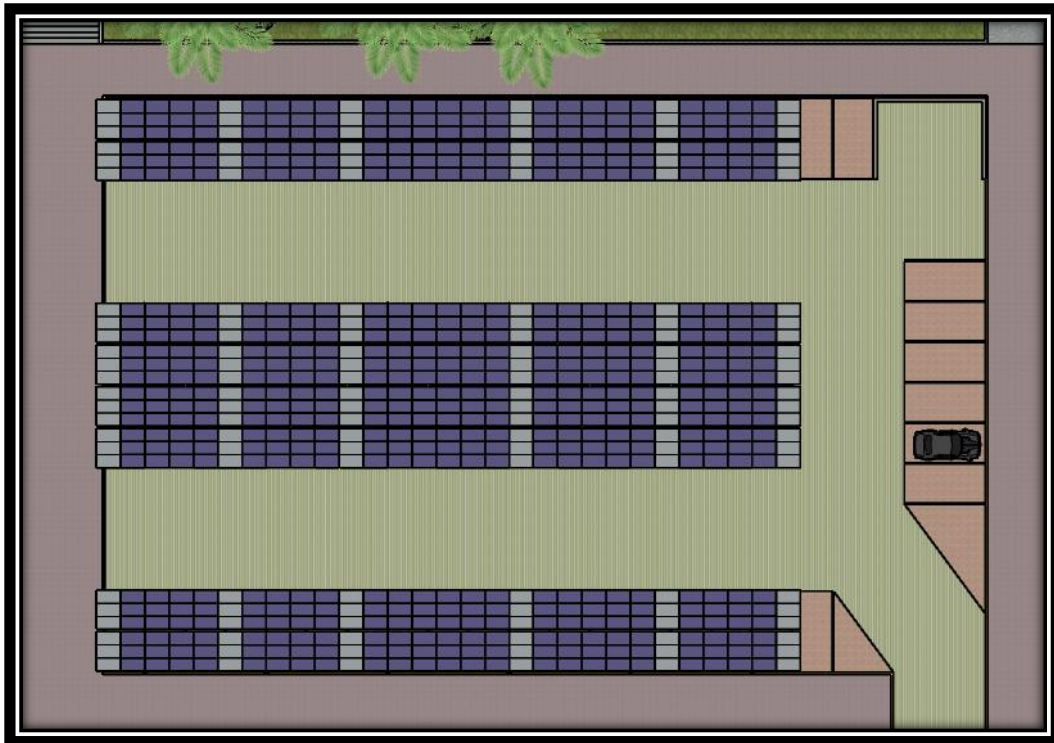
Estacionamiento Privado FIC. Elaboración Propia
